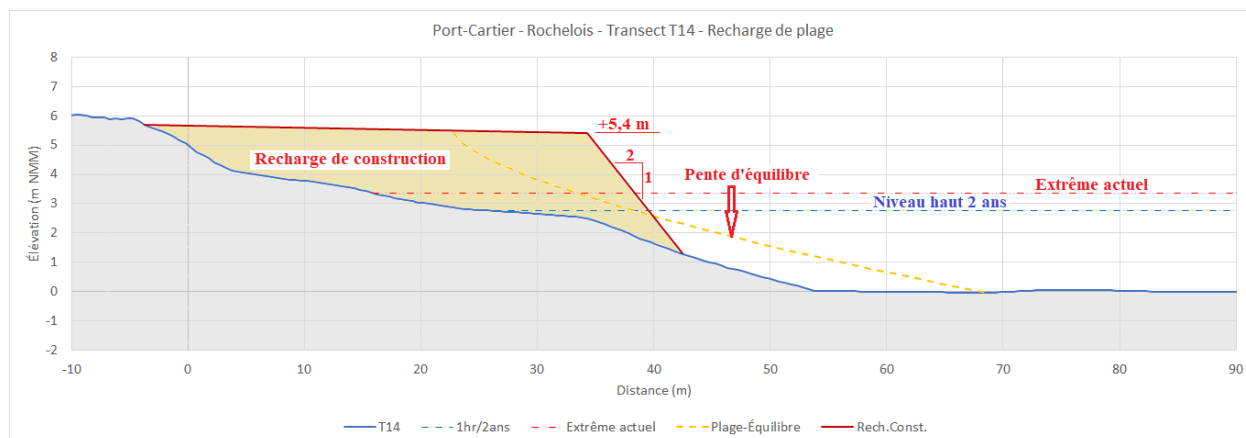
Coupe-type d'une recharge de plage (Transect T14)
